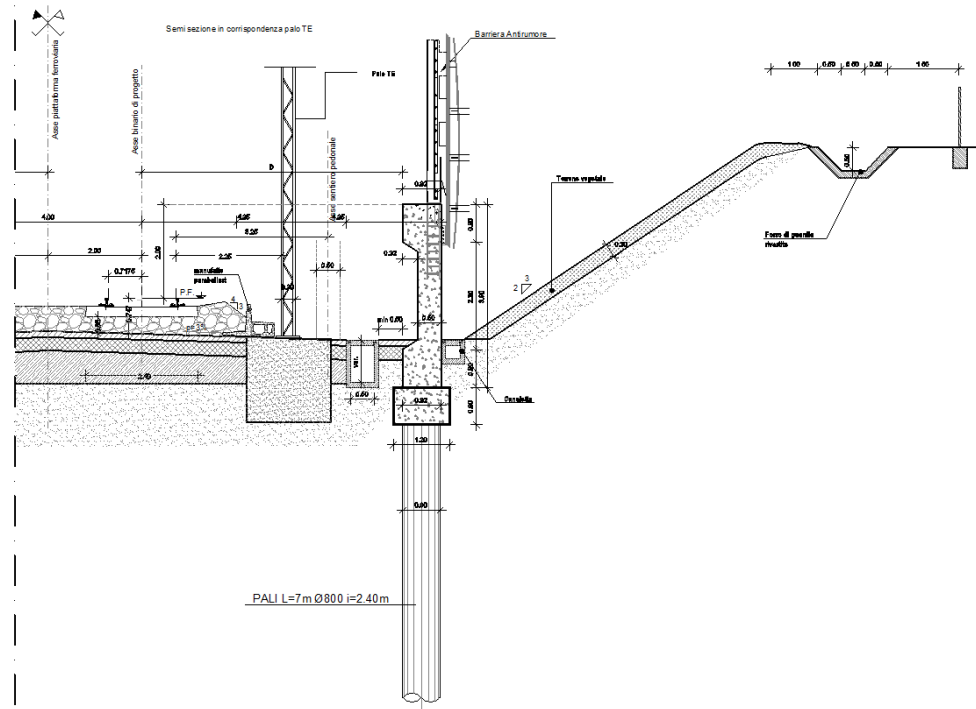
Sezione trasversale muro tipo B (particolare di muro in trincea, con distanza da asse binario >5.00m)
